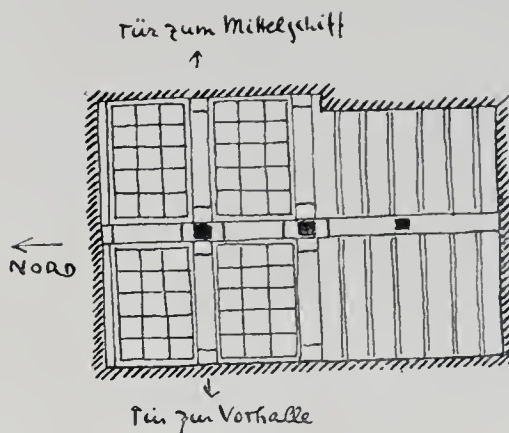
Grundriß der hölzernen Decke der inneren Vorhalle der Kirche zu Debra Damo.
